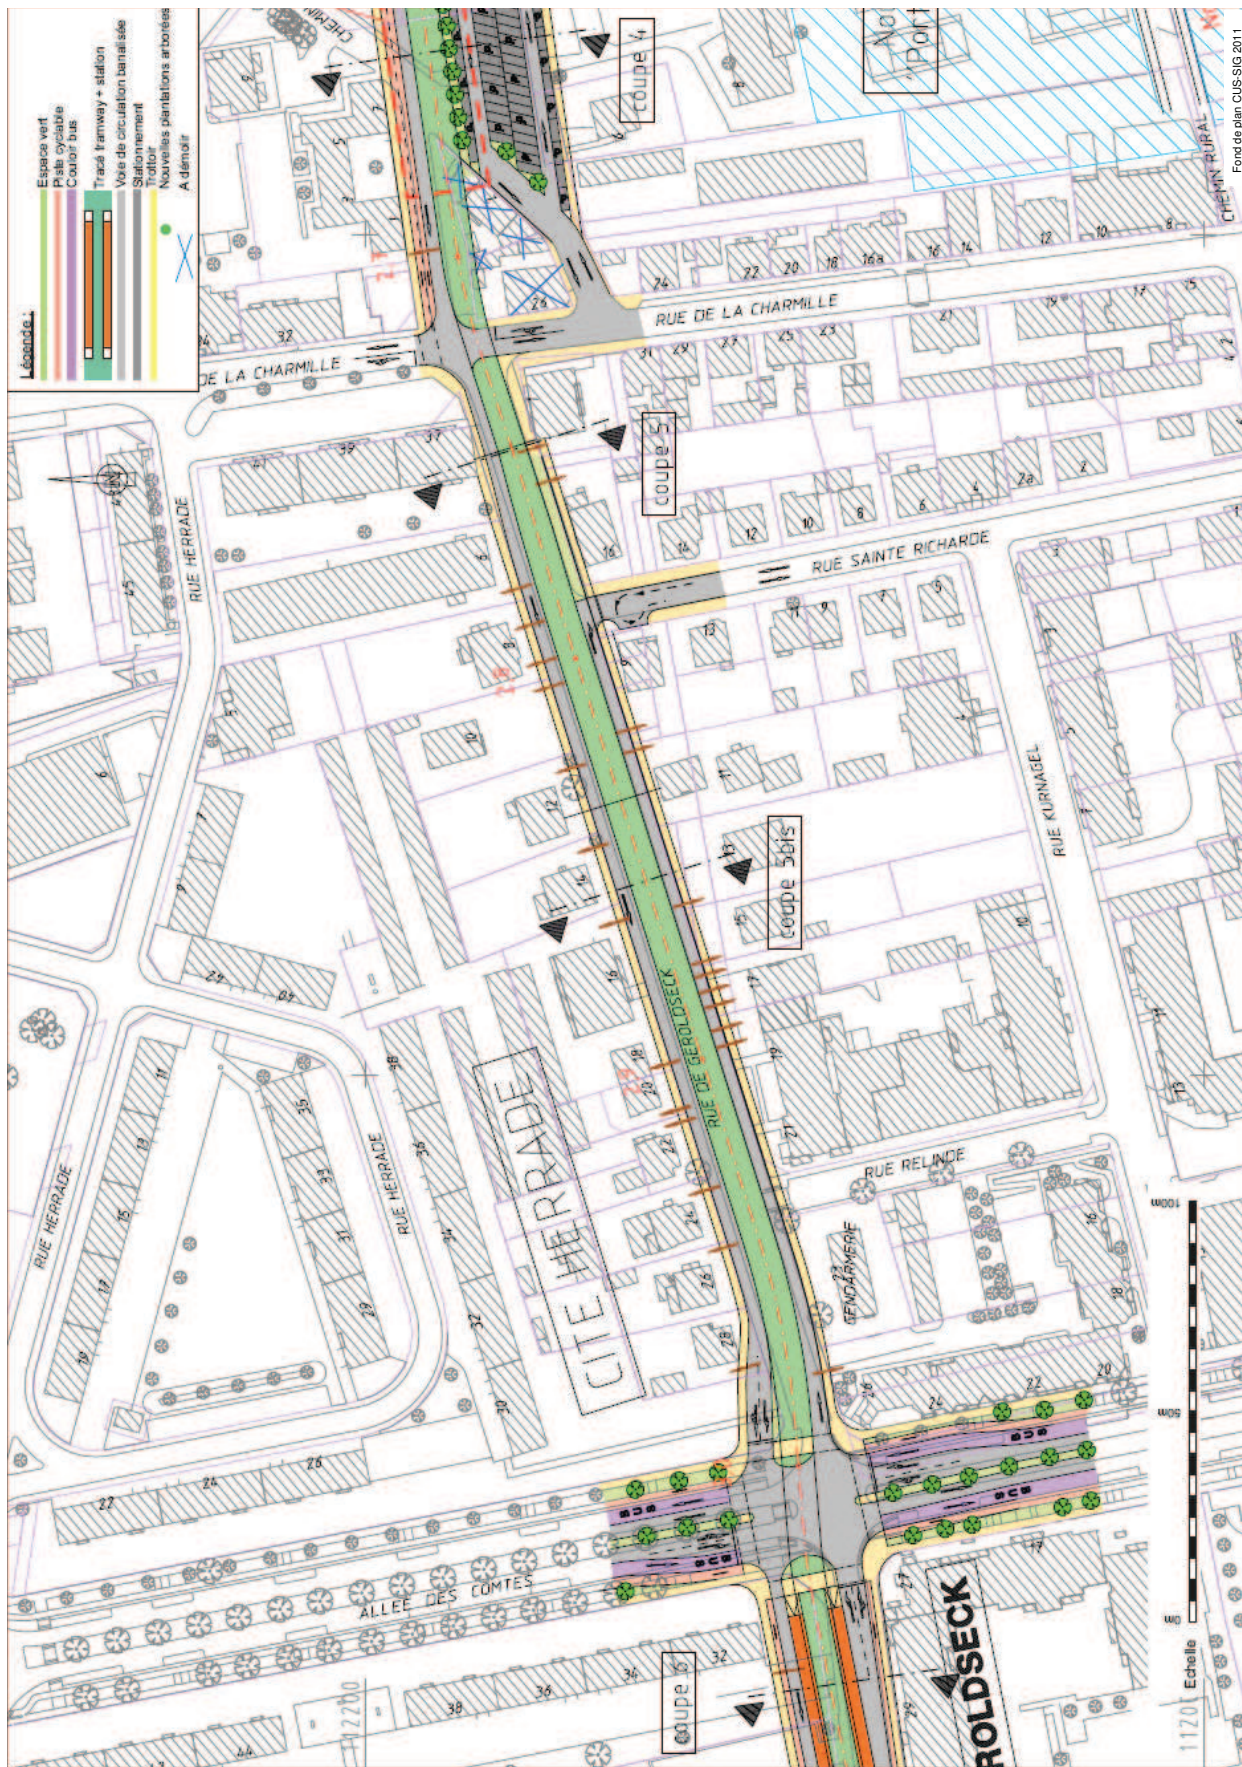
Plan zoom sur secteur "Géroldeck / Charmille" (option "site central")
